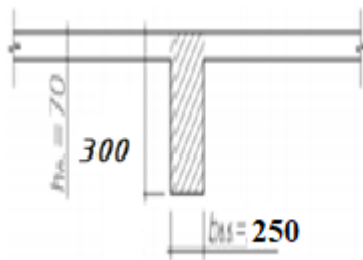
Расчетное сечение второстепенной балки при расчете на отрицательный изгибающий момент.
